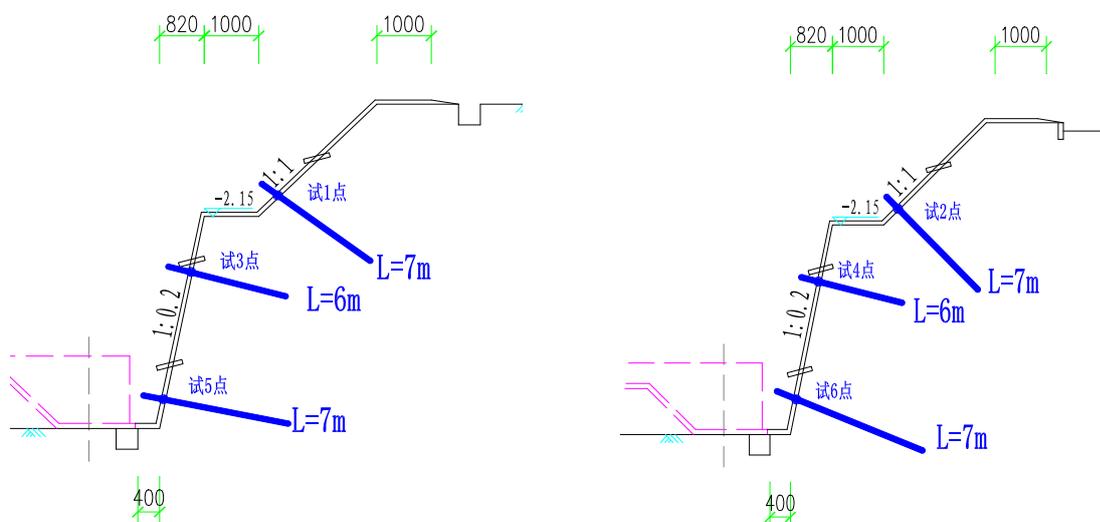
检测基坑土钉剖面示意图 (AA') 图 8.7 检测基坑土钉剖面示意图 (JA 段)
